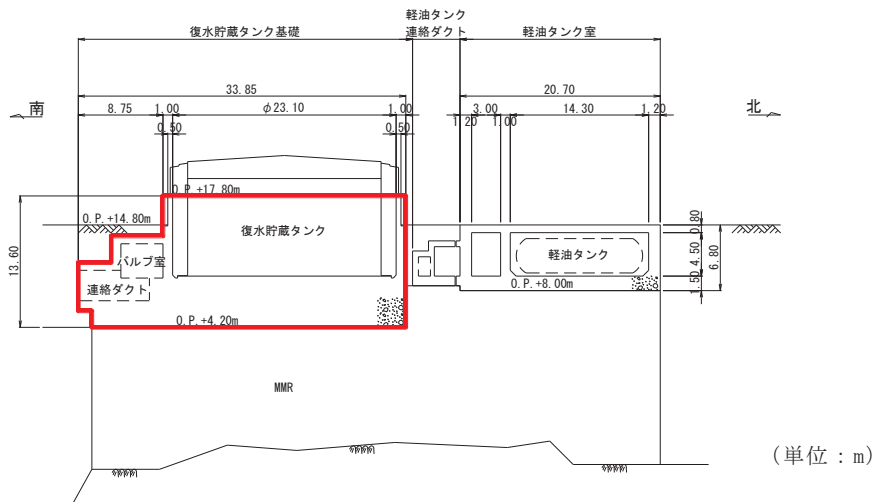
復水貯蔵タンク基礎断面図 (A-A 断面, 南北)
